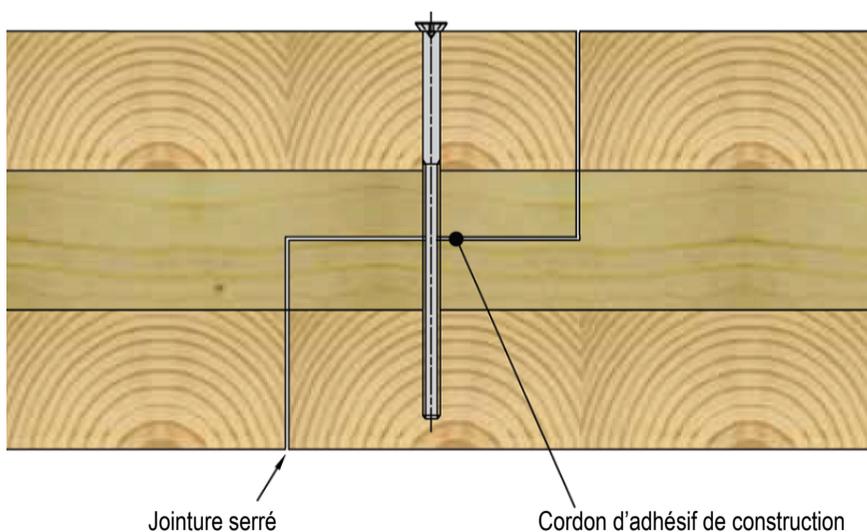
Illustration d'un détail d'un joint à demi-bois entre deux panneaux de CLT (FPInnovations, 2011)
